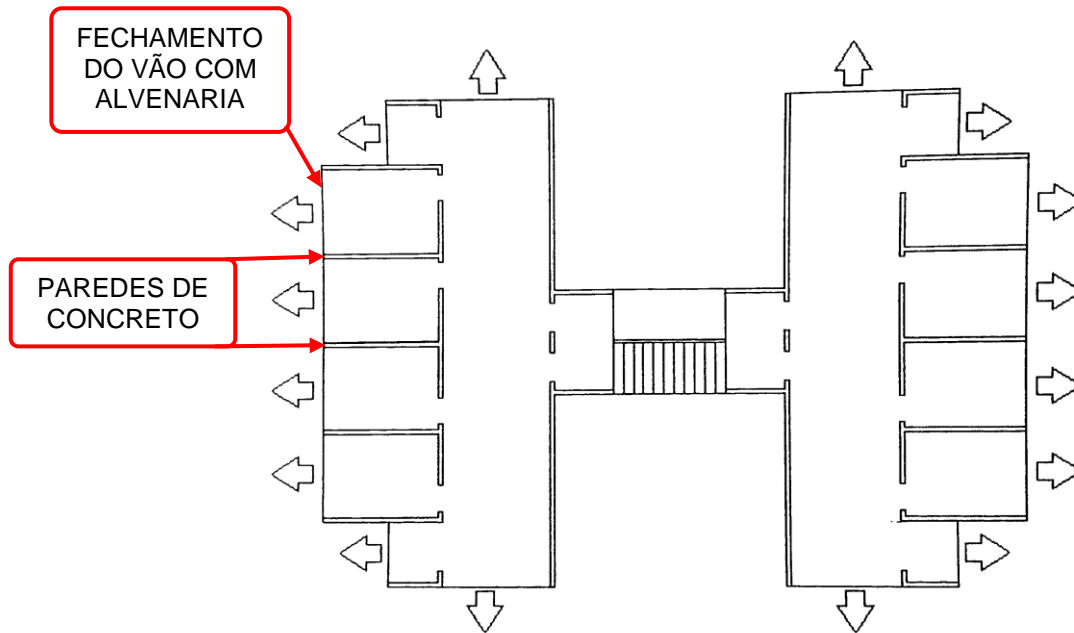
Esquema de posicionamento / deslizamento das fôrmas-túnel empregadas na moldagem de paredes e lajes (IPT, 2007).
